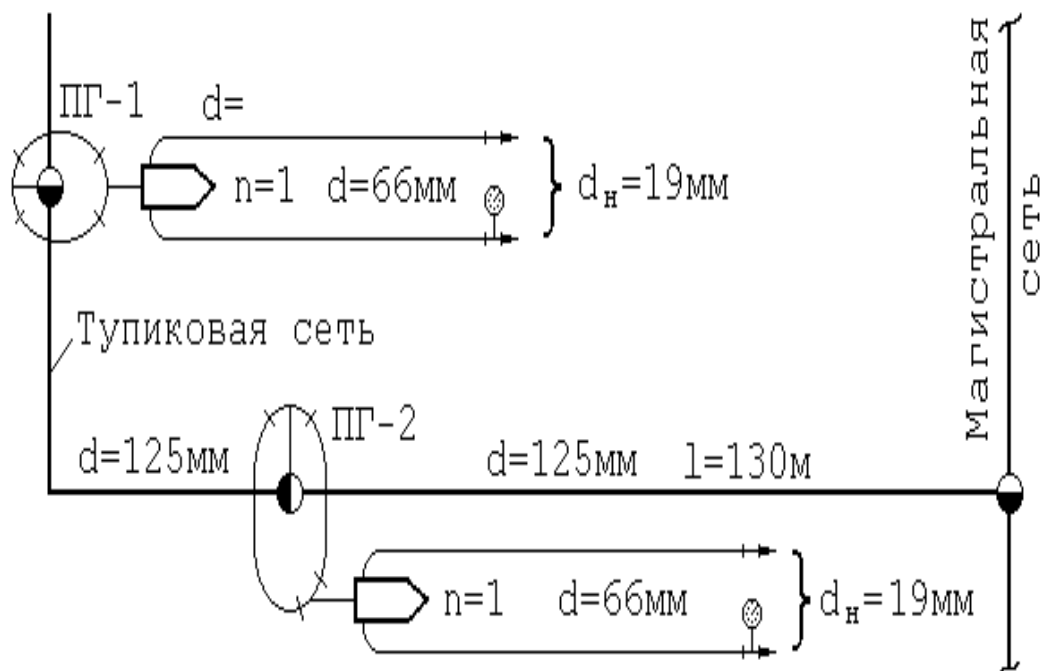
Схема испытания водопроводной сети на водоотдачу
